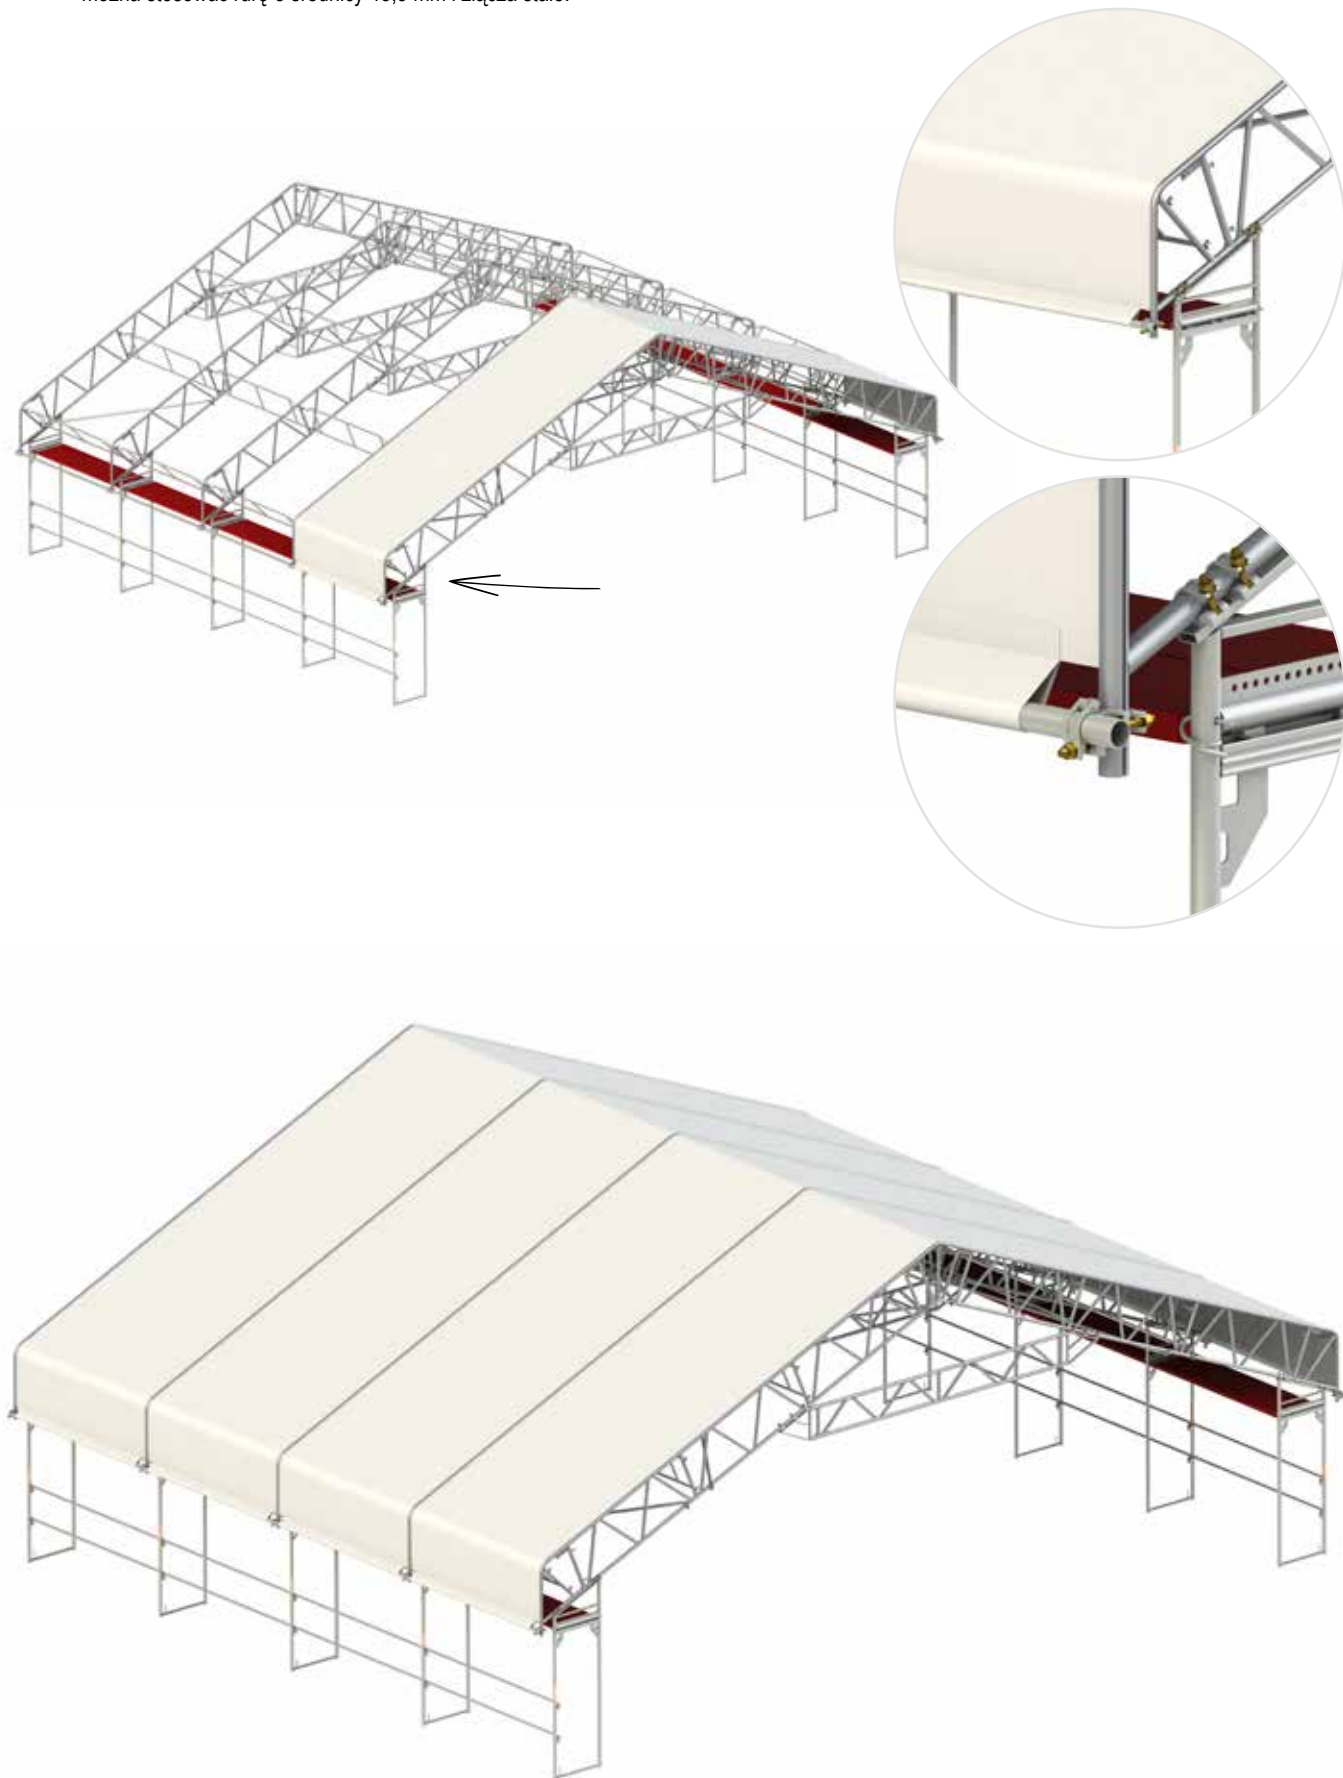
Przykładowe etapy montażu dachu z wykorzystaniem dźwigu.
